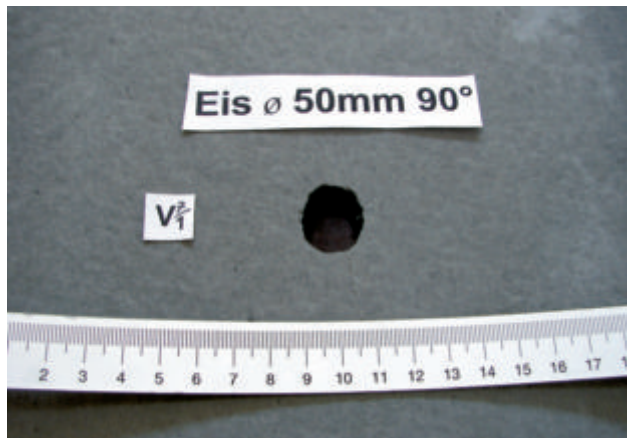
Panneaux de façade en fibres-ciment, photo Empa.
